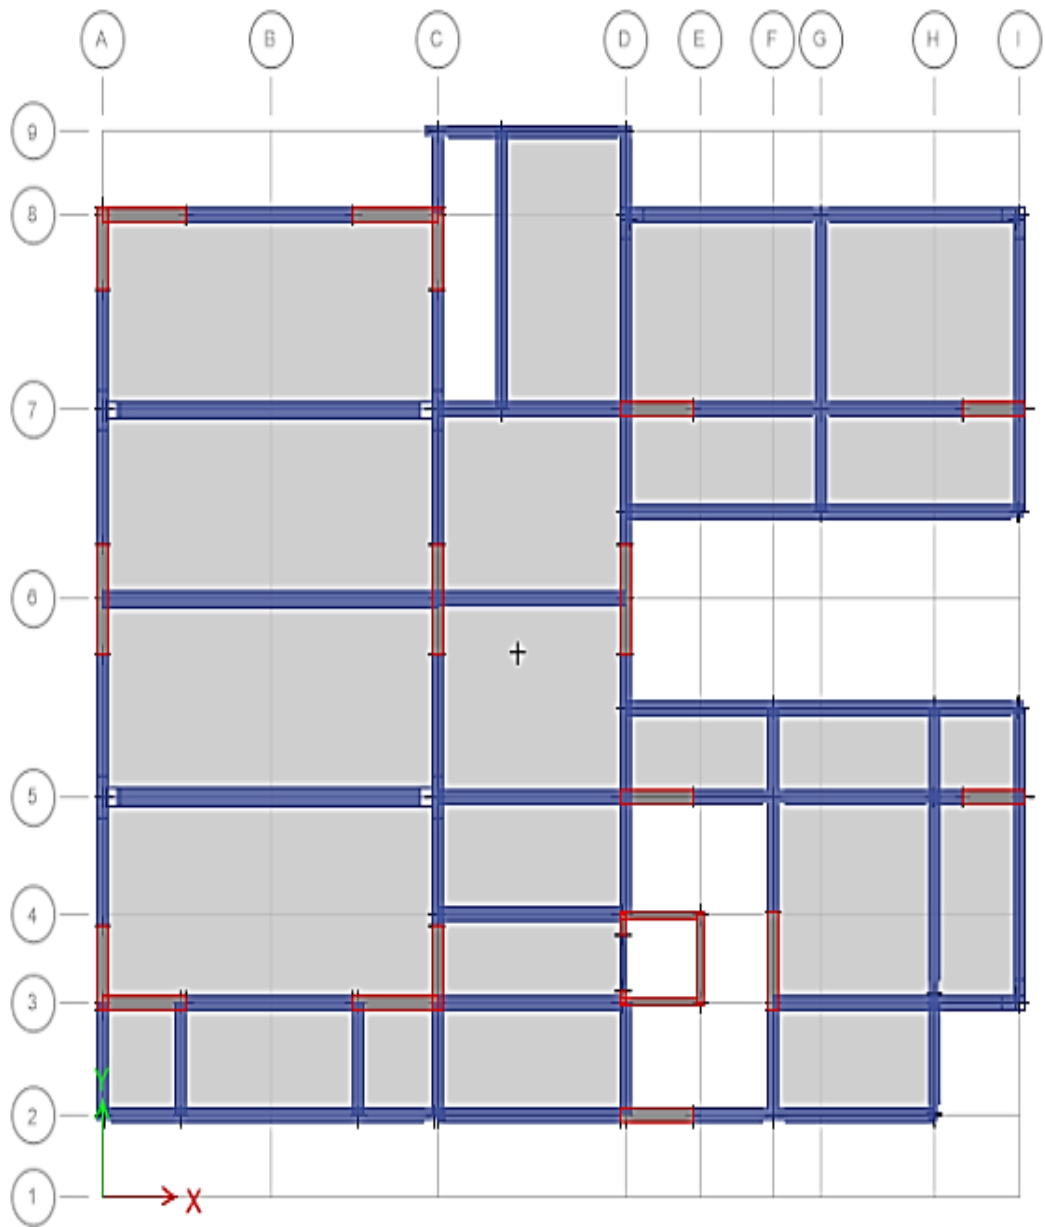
Vista en planta de Edificación (1° - 4° nivel)
